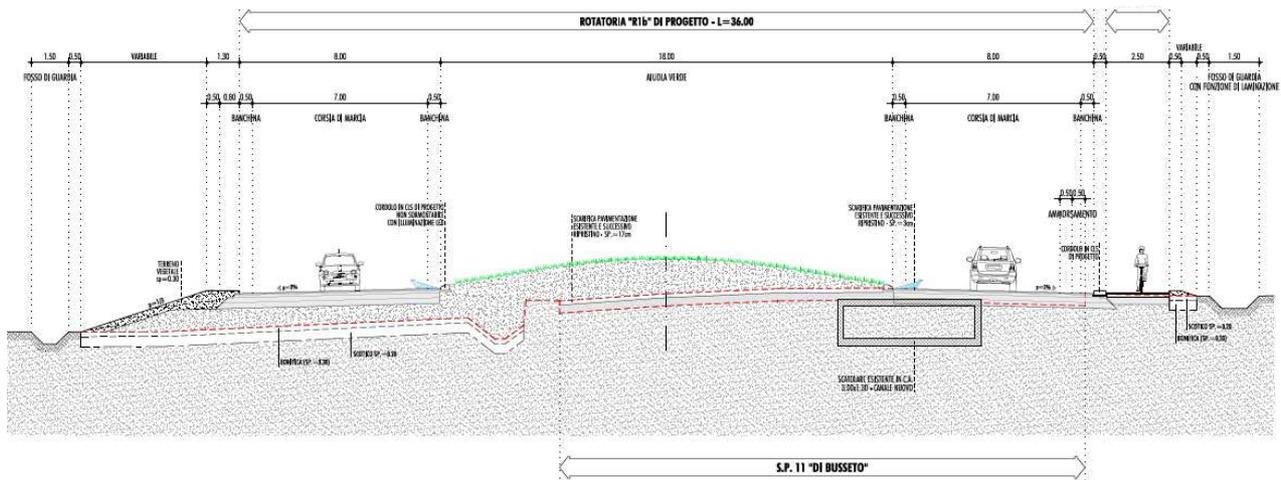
INTERSEZIONE S.P. N° 11 – STRADA DEL TORCHIO: SEZIONE TRASVERSALE TIPO
